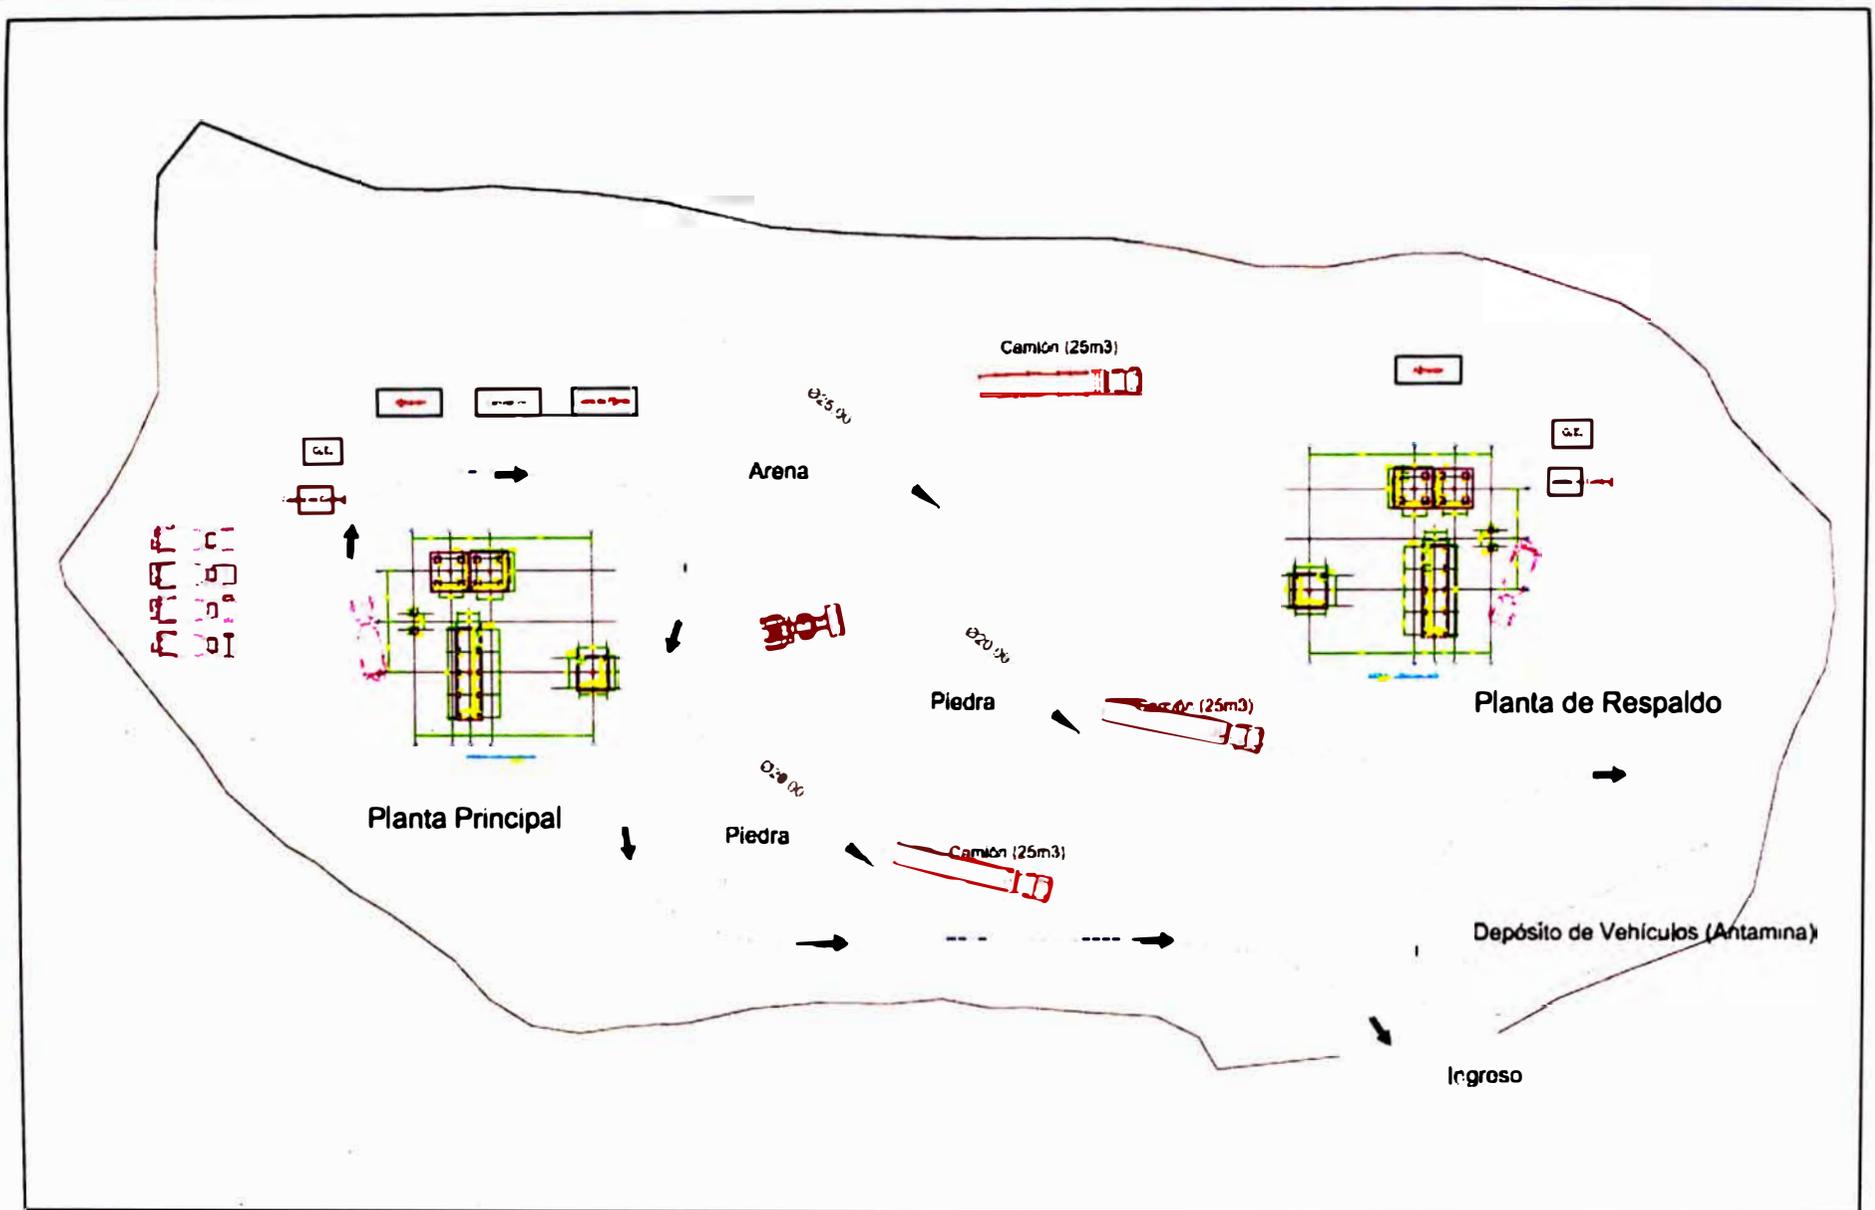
Layout inicial de la Planta de concreto (Fuente: Oficina técnica de planta)
